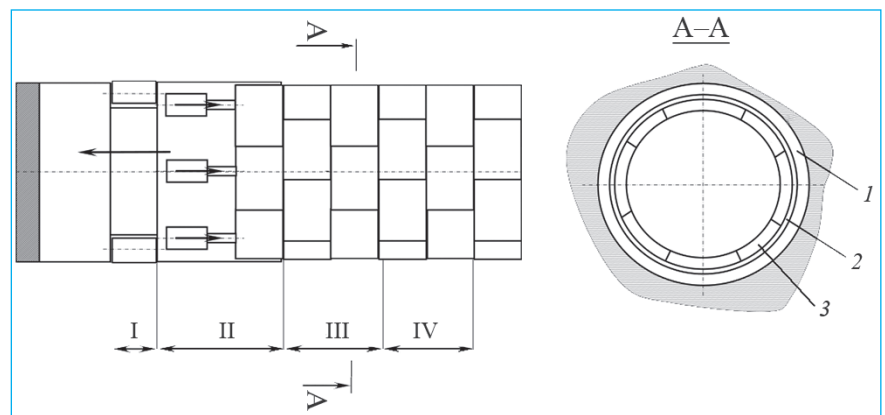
Схема утворення кріплення з обробкою приконтурного ґрунтового шару: 1 – оброблений ґрунт; 2 – тампонований піщаний бетон; 3 – збірне залізобетонне кріплення.
